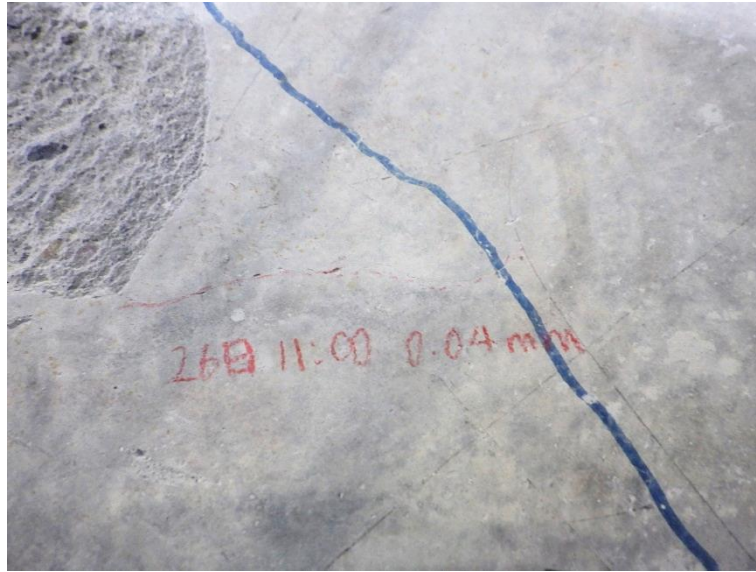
供試体端部のひび割れの発生状況 (2/2)
